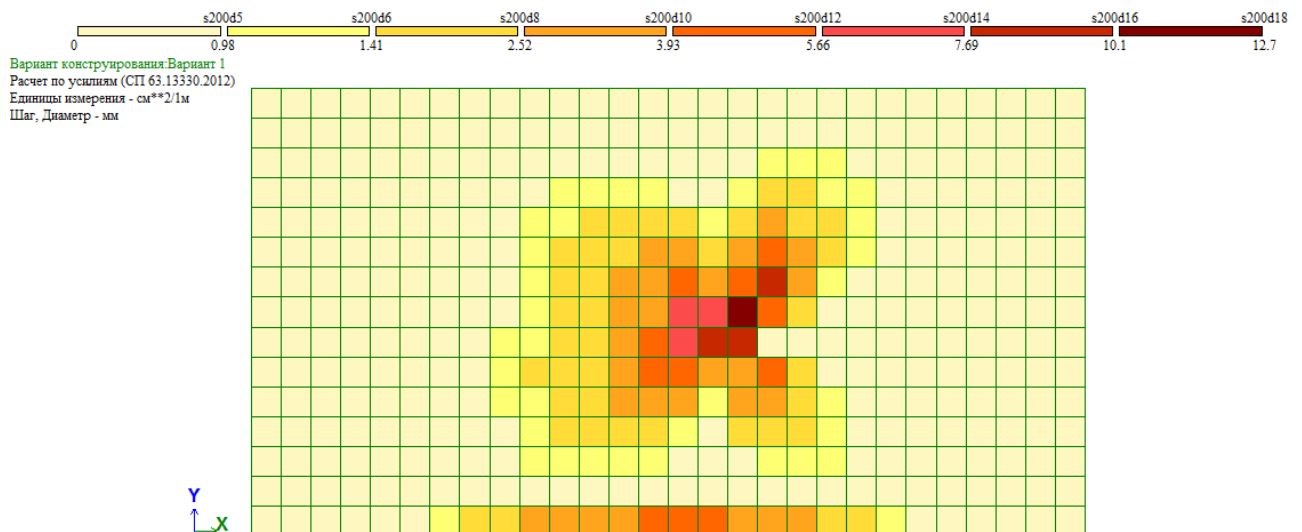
Площадь арматуры на 1 погонный метр по оси Y у нижней грани
